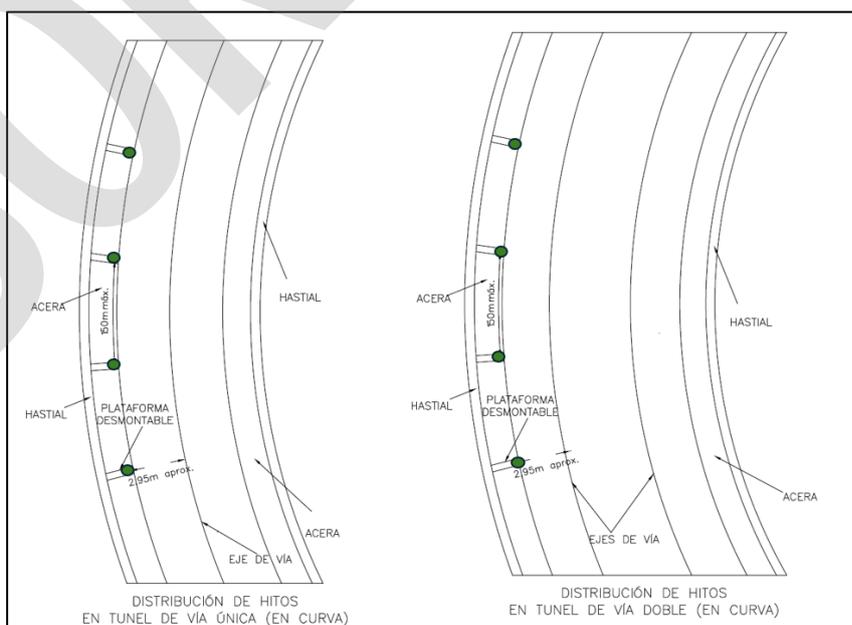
Detalle de colocación de hitos en túnel en tramo curvo.
